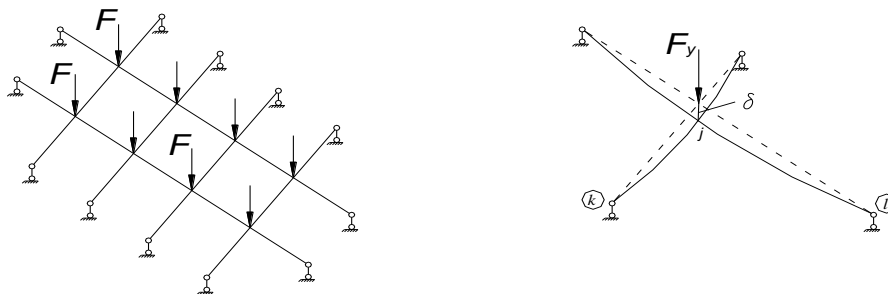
Structura de rezistență a planșeului [8]
